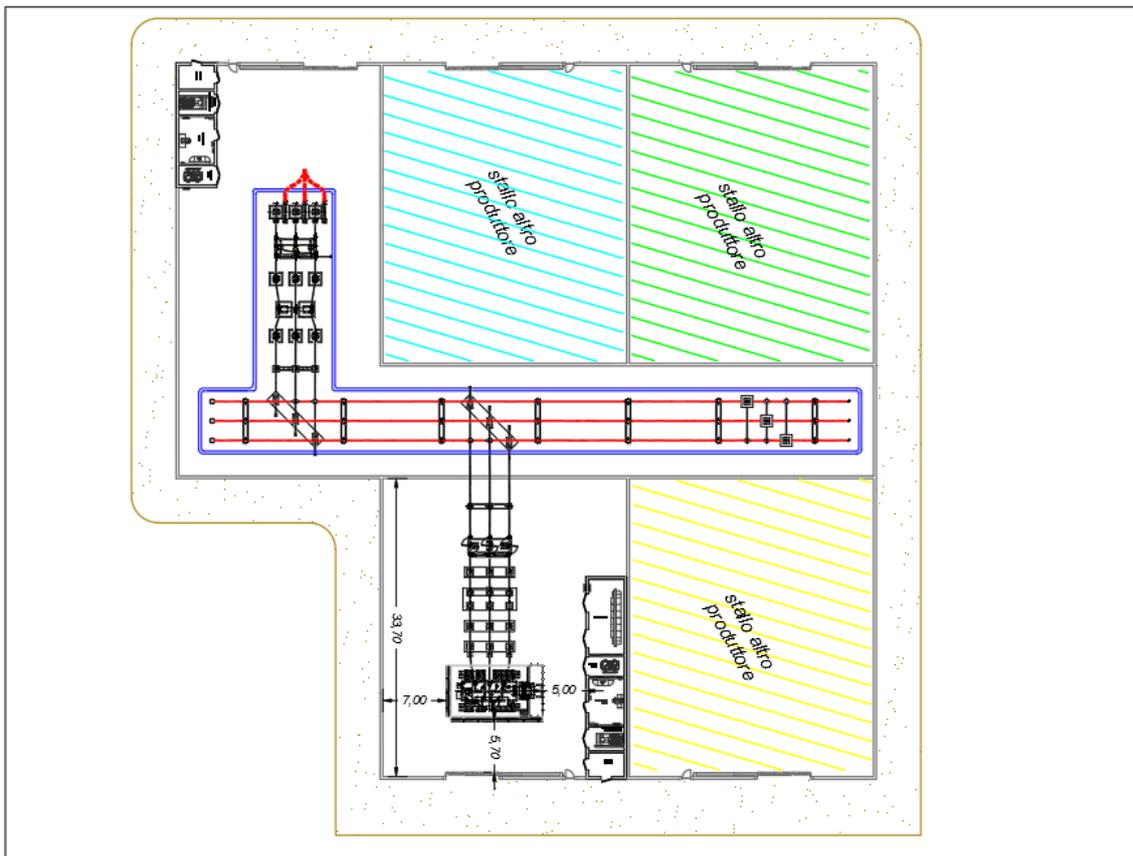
planimetria elettromeccanica Sottostazione Elettrica di Utente della Società Proponente e delle Opere AT da condividere con altri Produttori
